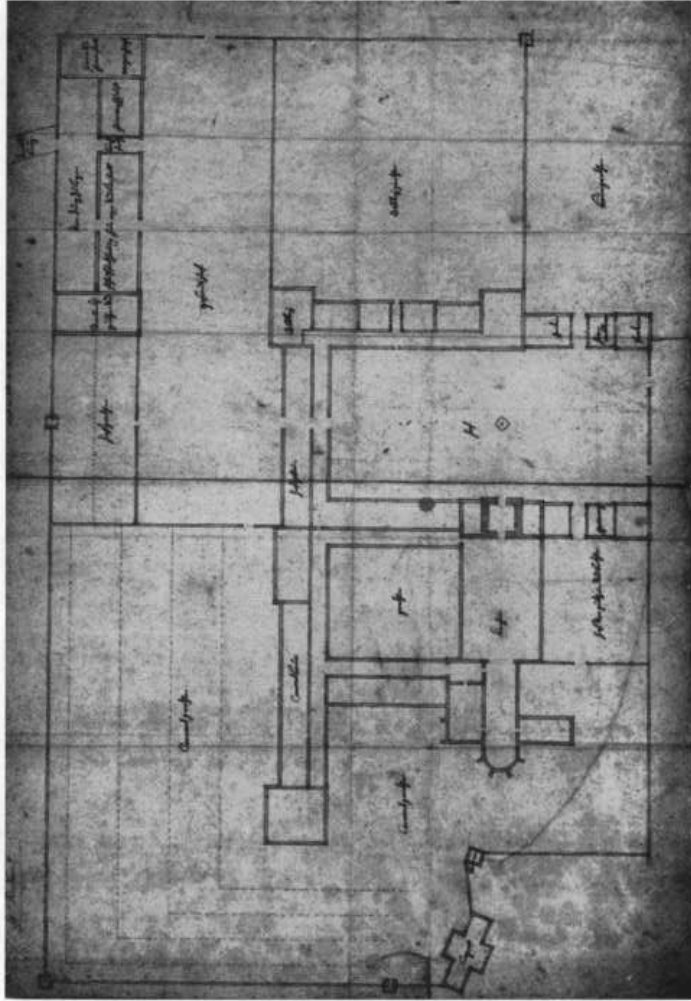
Grundrißzeichnung des Klosters von P. Thumb (?), welche dem nach 1738 bzw. 1742 teilweise zur Ausführung gelangten II. Projekt des Baumeisters zugrunde liegt (GLA Karlsruhe).
